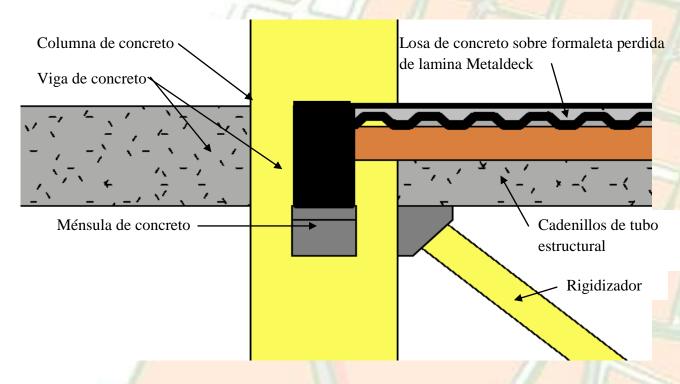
Detalle constructivo de columna, viga y entrepiso. Fuente: propia.
